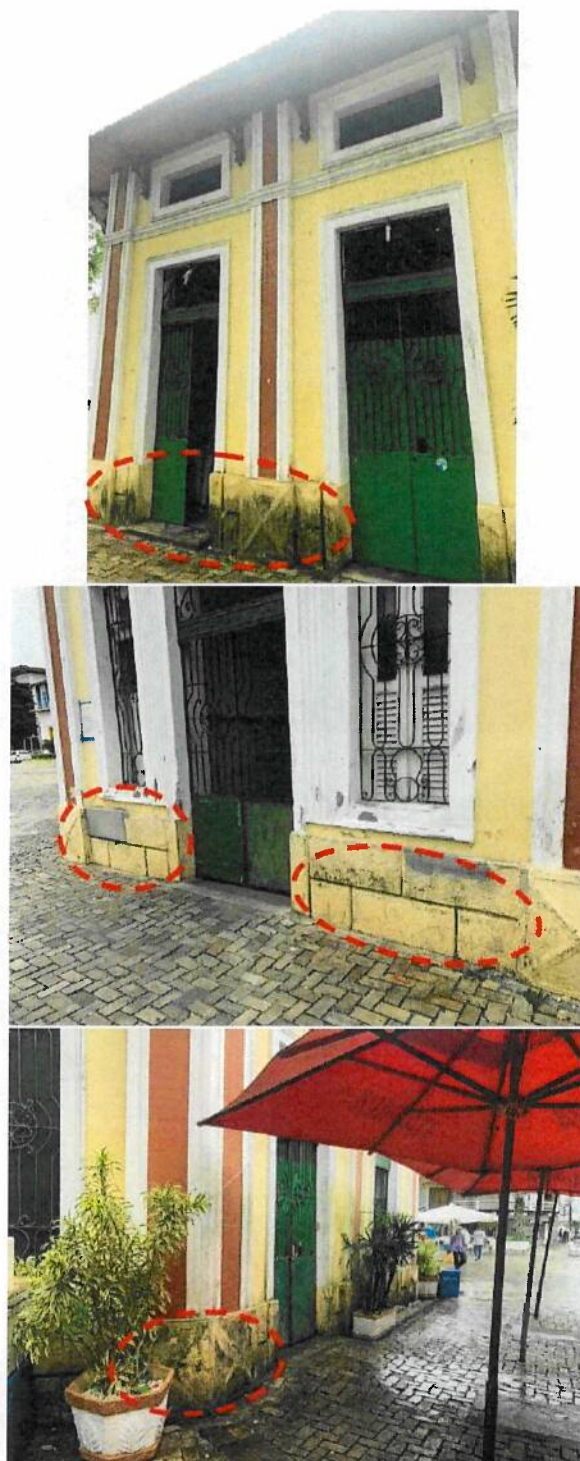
, 11 e 12 – Imagens das fachadas, com foco nas manchas de capilaridade e na recomposição da fachada com cimento. Fonte: INEPAC
